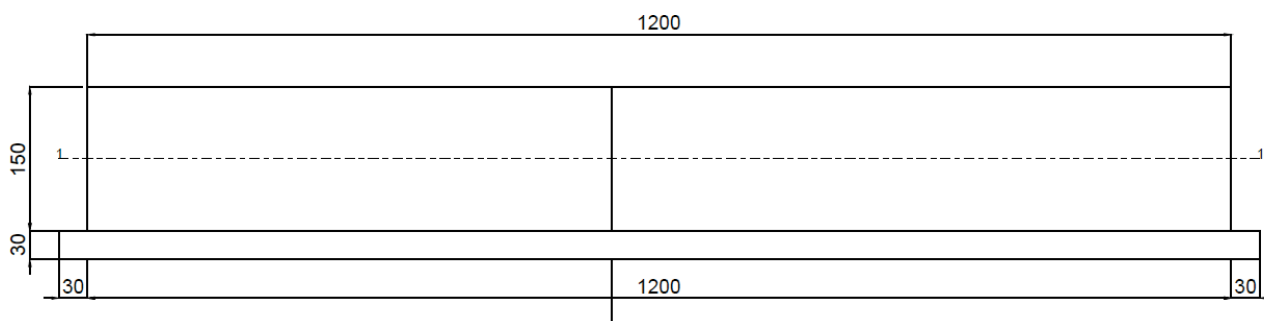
Sezione longitudinale dell'opera di attraversamento dell'impluvio
